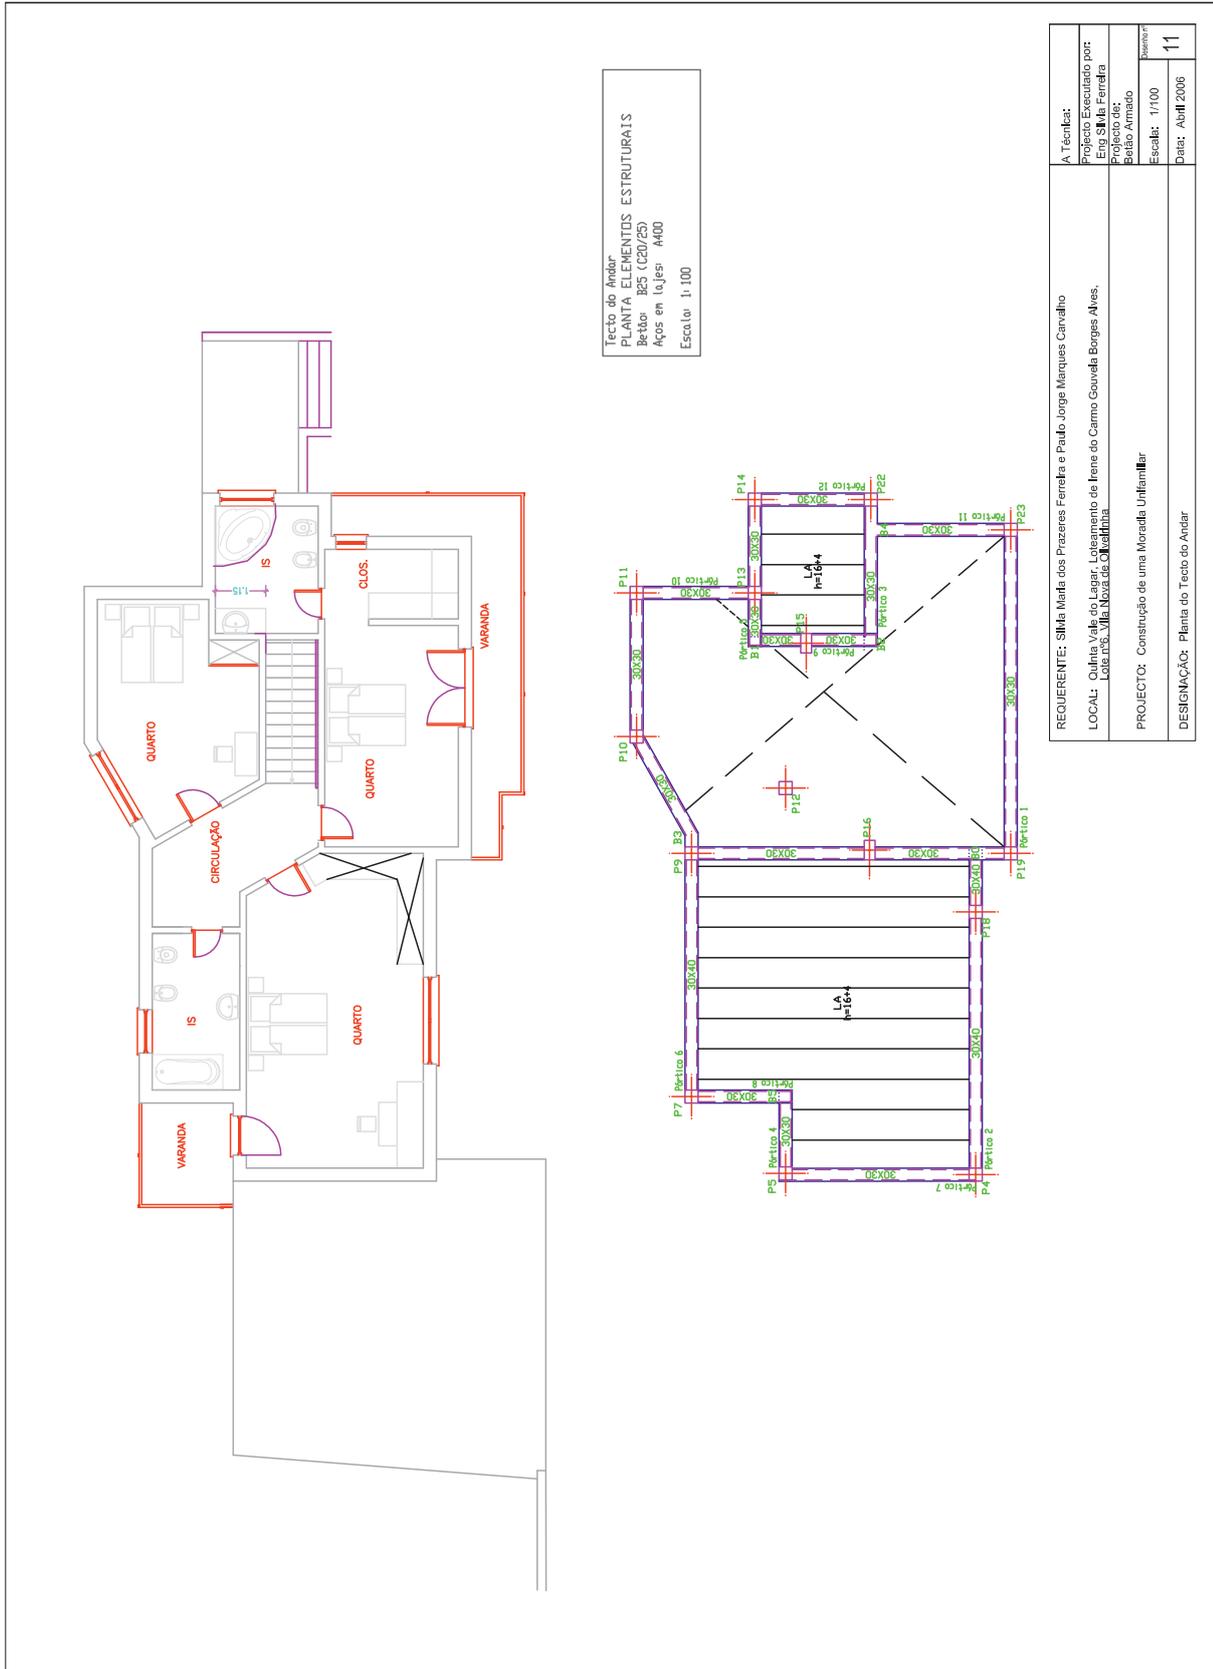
Planta de arquitetura/estrutural do piso 1 da solução em BA
